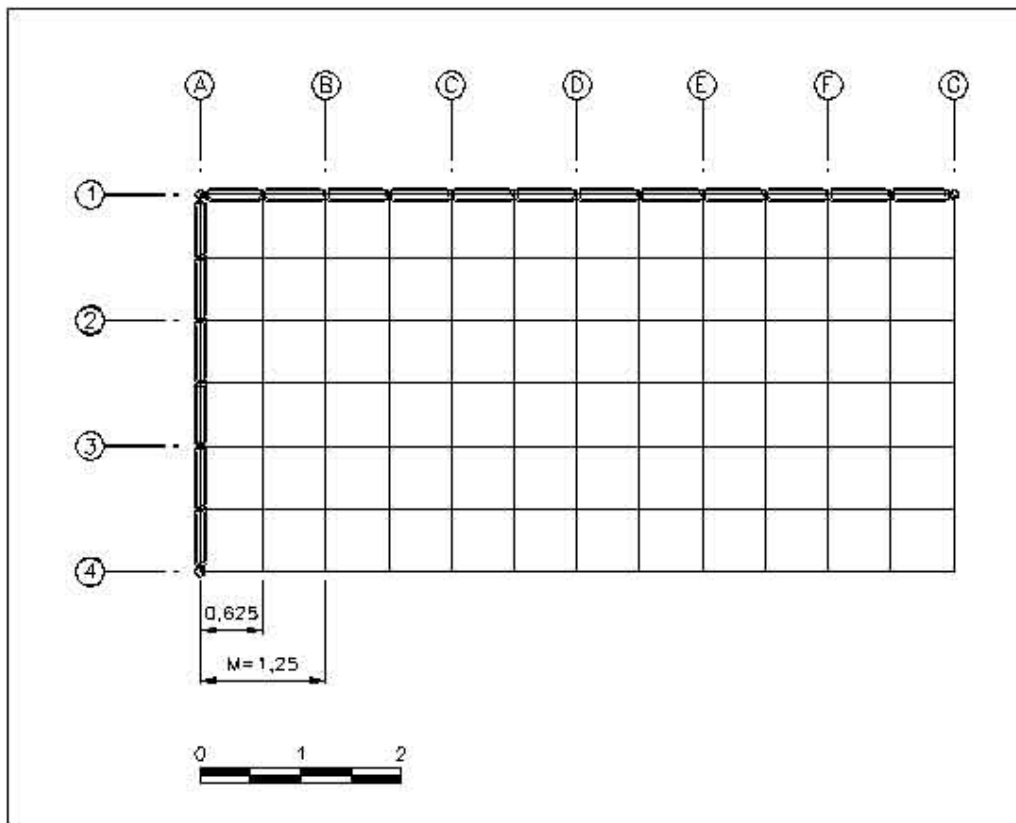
O desenho acima representa esquematicamente o sistema construtivo desenvolvido para a execução dos hospitais da Rede SARAH. O módulo (M) utilizado mede 1,25 m, do qual derivam as dimensões dos elementos construtivos. Observa-se a modulação do piso (peças de prensado melamínico) e das paredes (placas de argamassa armada em pares), cujos elementos tem como medida um submúltiplo do módulo (62,5 cm, metade de M). A modulação estrutural também obedece a essa medida, sendo que as distâncias entre os pilares (eixo A a eixo G e eixo 1 a eixo 4) são múltiplos do 1,25 m.
